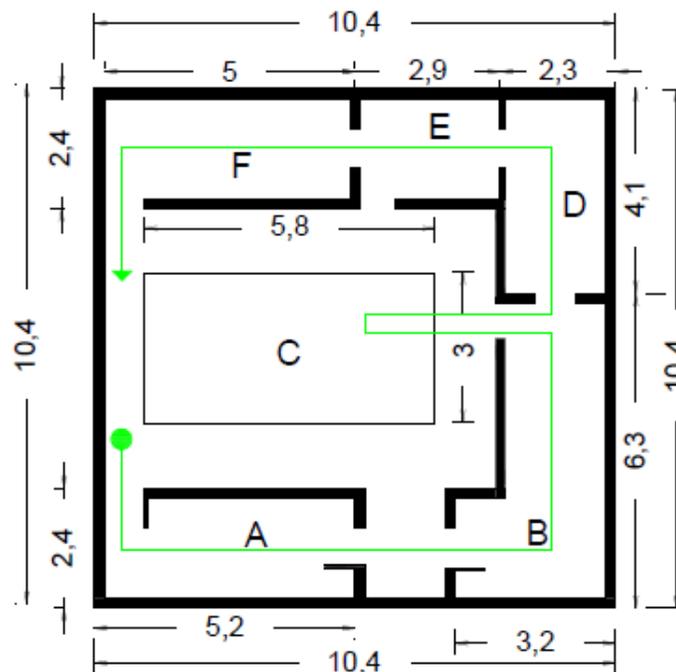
Layout planta de producción ChocoArtesanos (Fuente: Elaboración propia)
